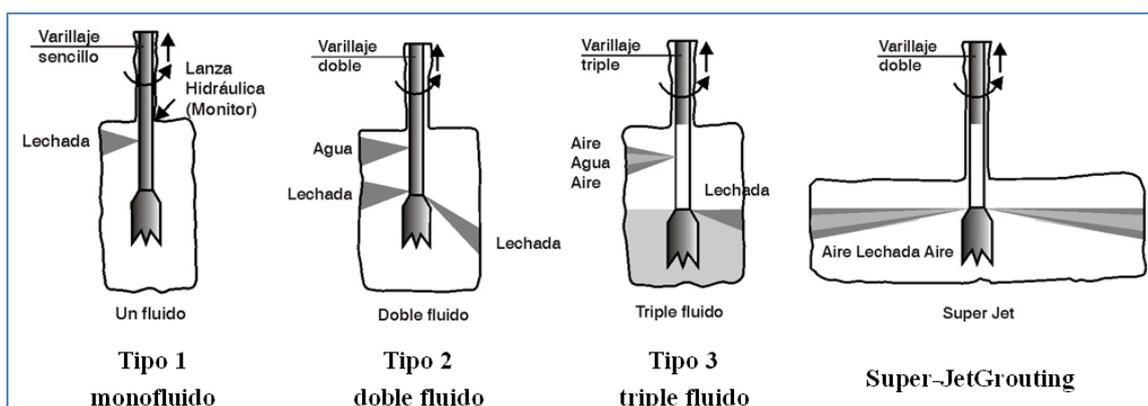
Esquema de súper jet grouting y de los sistemas convencionales Tipo 1, Tipo 2A y Tipo 3.
